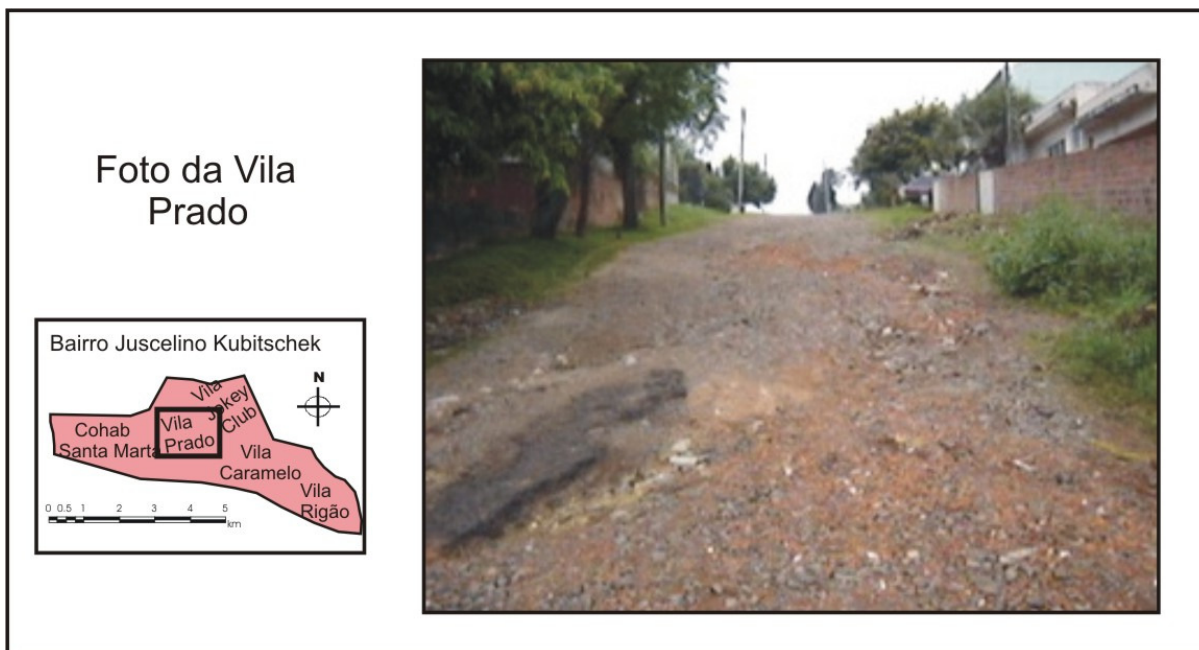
Foto da Vila Prado – pavimentação precária e falta de bueiros
